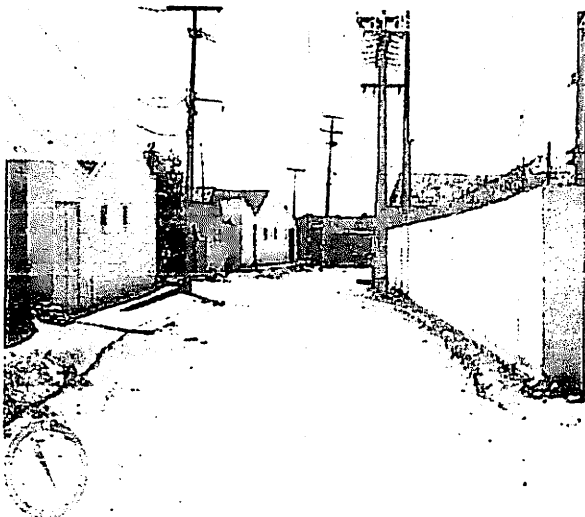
(Rua Projetada 01 - Vila da Papa)
